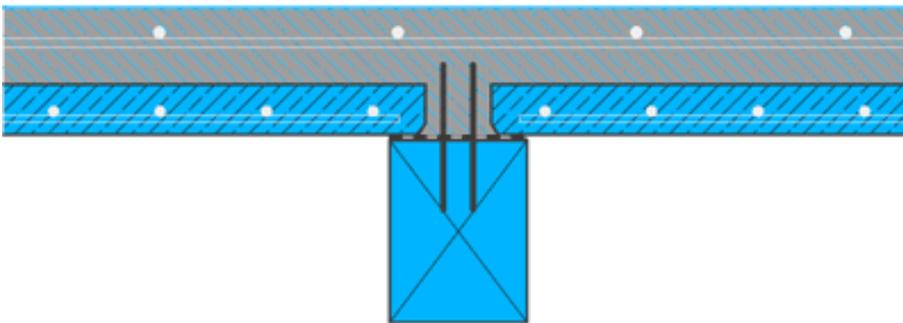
Holzbalken und Ortbeton¹⁴⁰
